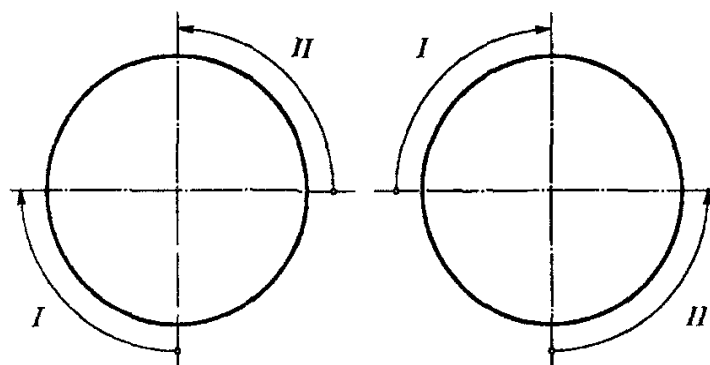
Порядок сварки корневого слоя шва неповоротного стыка
